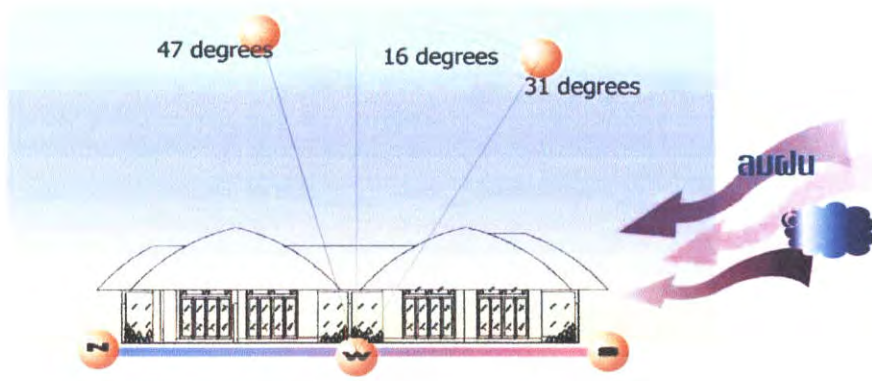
แสดงผลกระทบต่อโครงการจากสภาพแวดล้อมขยายส่วน Suit Villa
